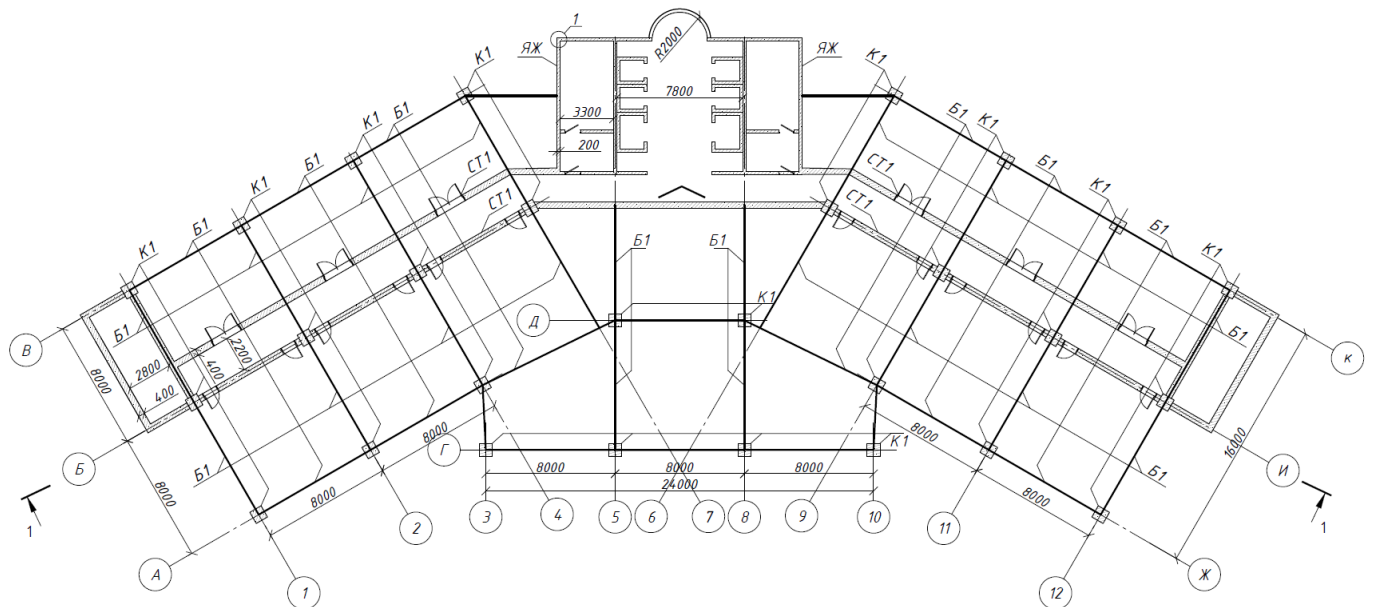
Схема расположения несущих элементов железобетонного каркаса
